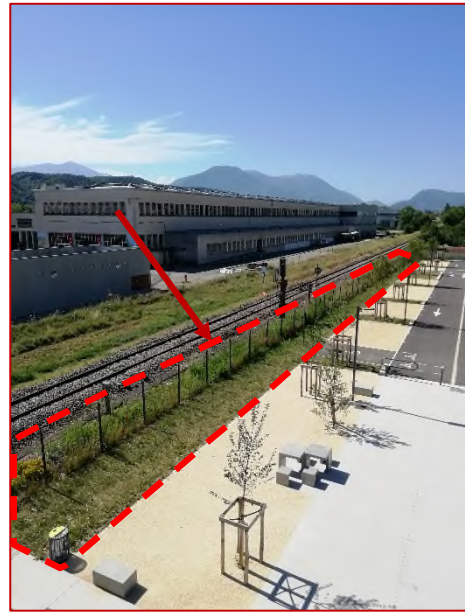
zone d'implantation de la future halte voyageurs (vue depuis la passerelle enjambant la voie ferrée)
